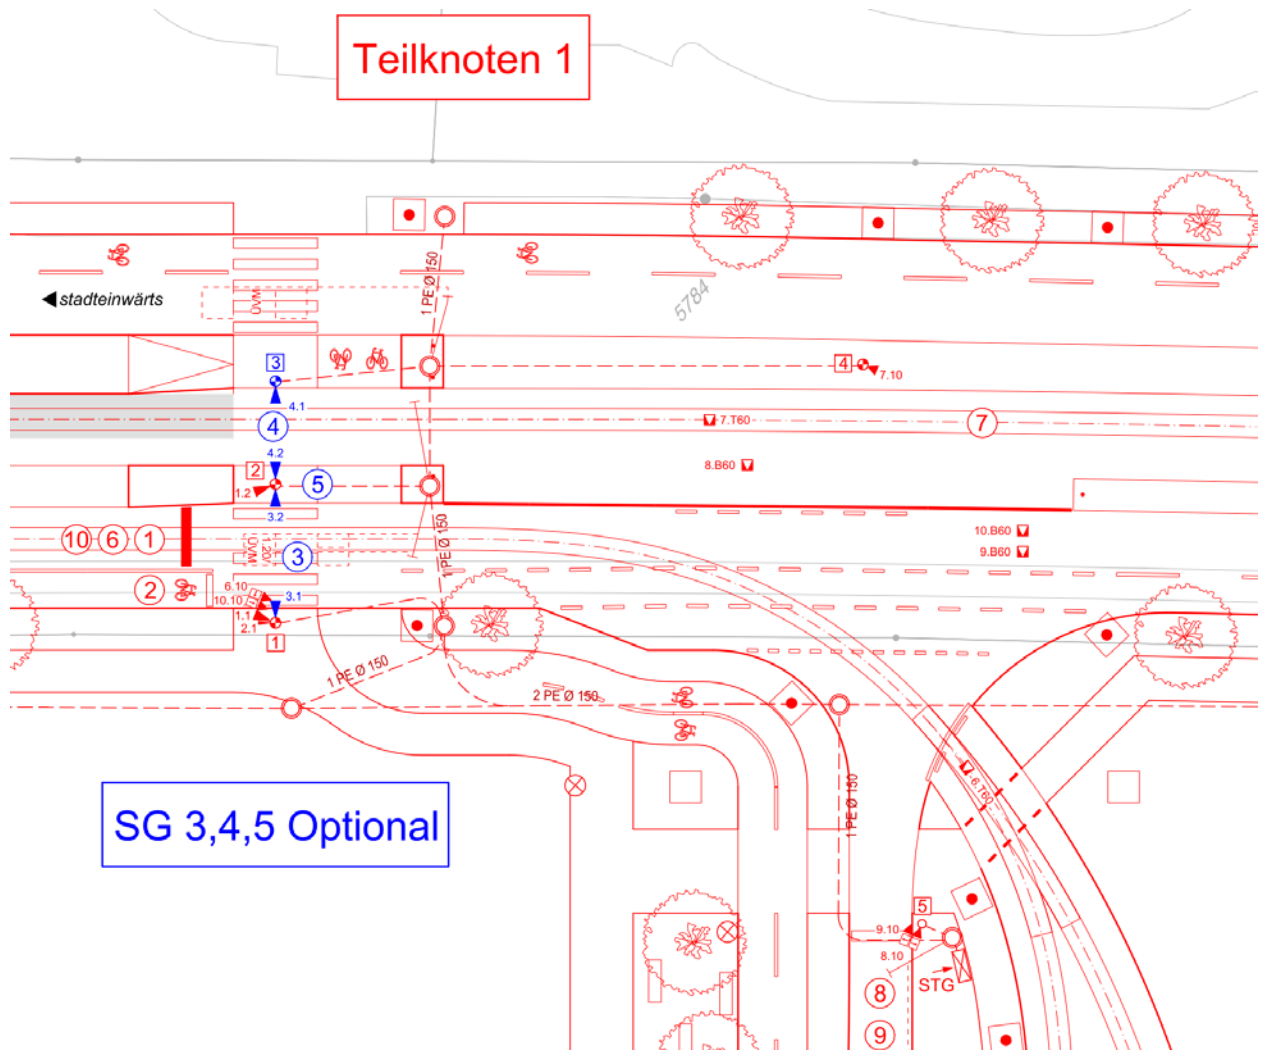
Situation mit Projekt [vgl. Plan-Nr. SEFT1-26-32-003-205]
